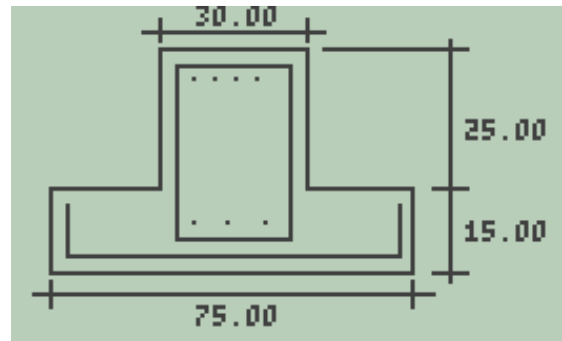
Sapatas Associadas - Detalhamento da viga, seção transversal.
